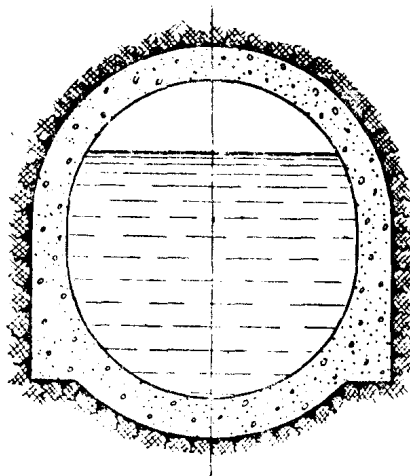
混凝土衬砌的水电站引水隧道截面图 (隧道内轮廓为复曲线形)
